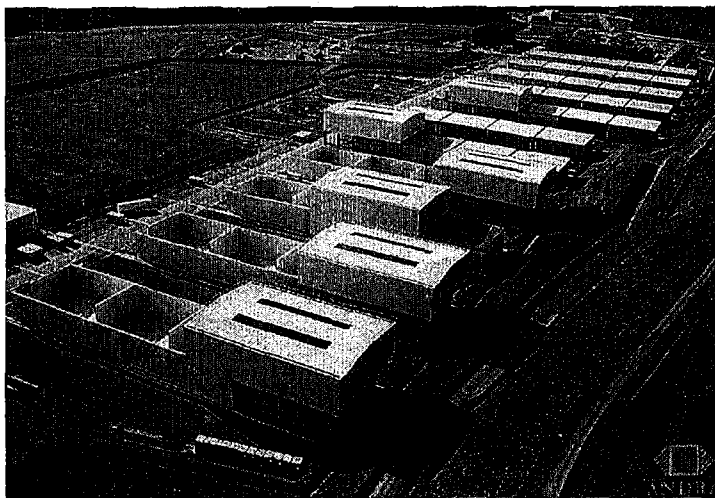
Хранилище РАО (ANDRA, Франция).
